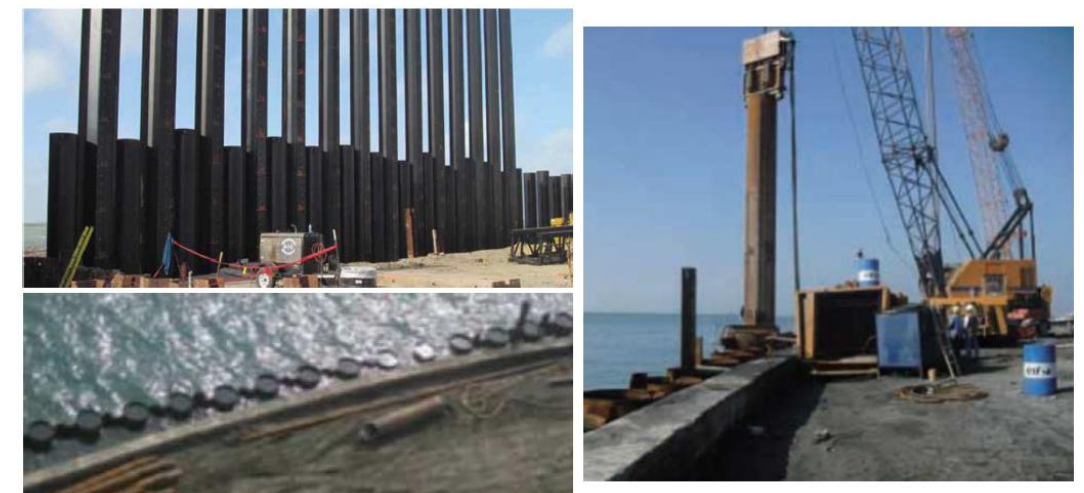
Exemple de chantier de type combiwall (pieux + palplanches)
